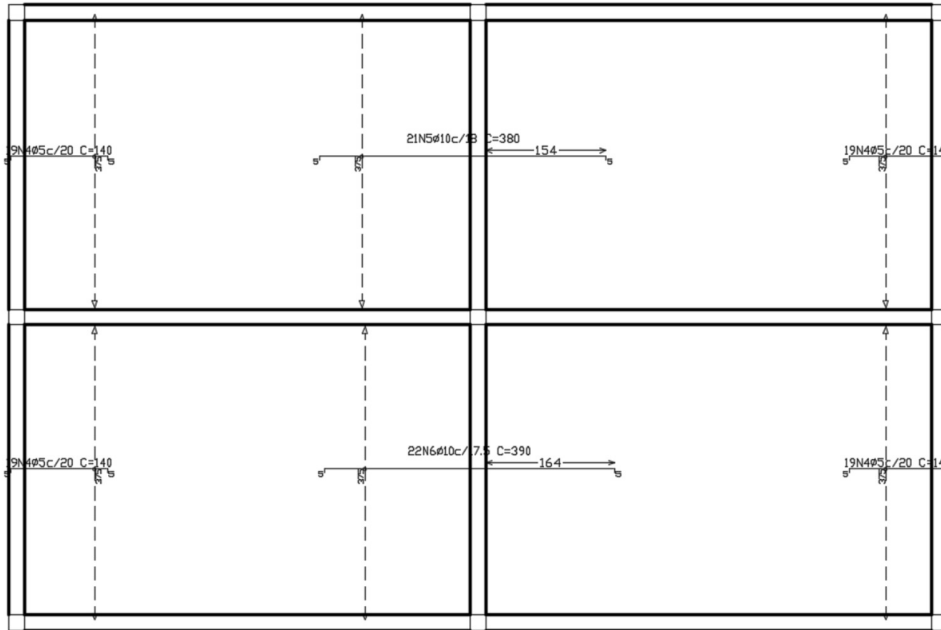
Armadura Longitudinal Inferior - Laje Maciça
